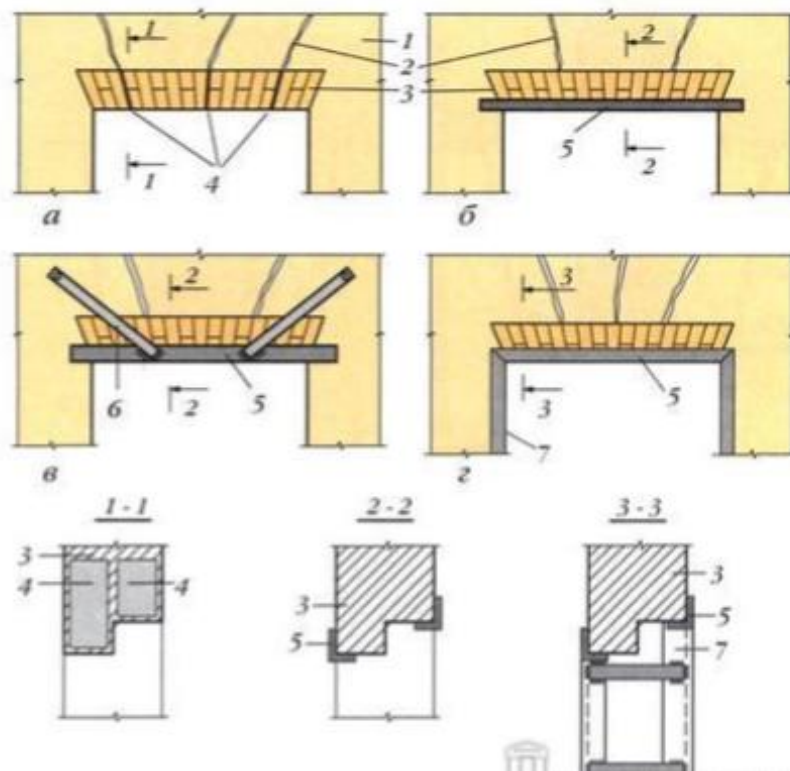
Усиление кирпичных перемычек: а -расклинивание трещин стальными пластинами; б, в -стальными уголками при небольшом (б) и длинном (в) пролетах; г -стальными уголками, соединенными со стальной обоймой простенков; 1 -кирпичная стена; 2 -трещина; 3 - перемычка; 4 -стальные пластины-клинья; 5 -стальной уголок; 6 -тяги из полосовой стали; 7 -стальная обойма простенка
